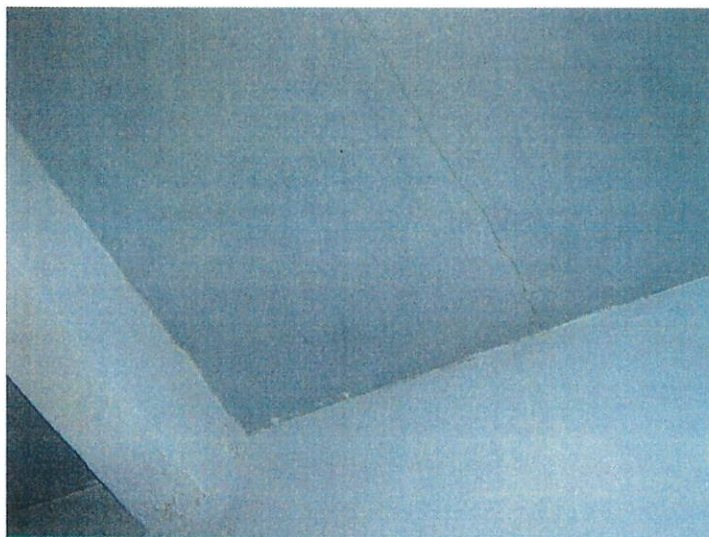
Sacristie - Fissure dans la dalle du toit
